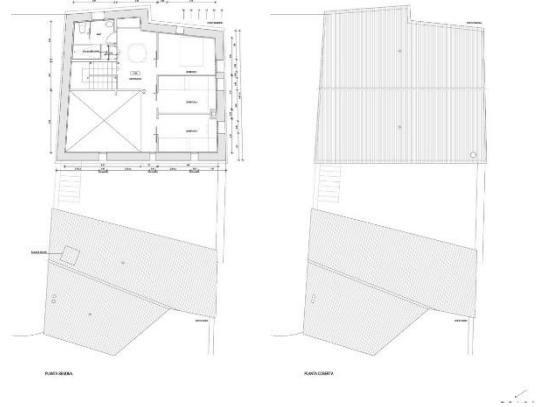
Planta segunda y cubiertas [Garcés de Seta Bonet]
